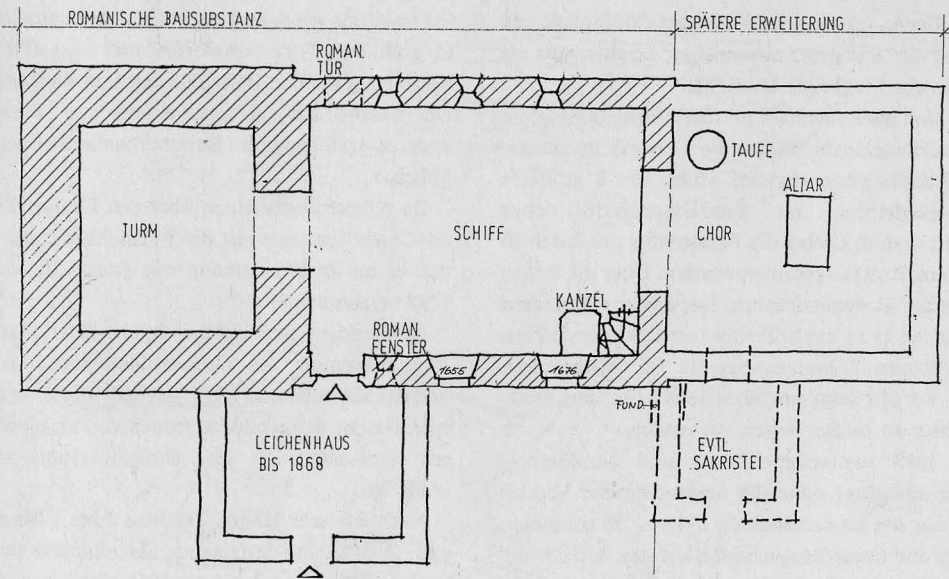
Kirche Eilum, vor dem Umbau 1749, Grundriß, Skizze, M 1:100, verkleinert auf 1:200. Vorlage: Umbauvorschlag J.-F. Struck, 1728
